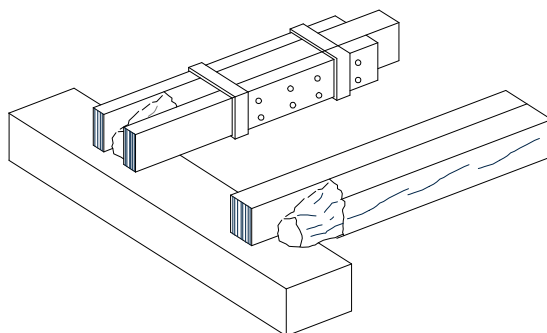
Apeo de las cabezas de las vigas con una línea adosada al muro (carrera de madera, perfil metálico y ménsula de hormigón armado). ("Intervención en estructuras de madera". ALTIM)
